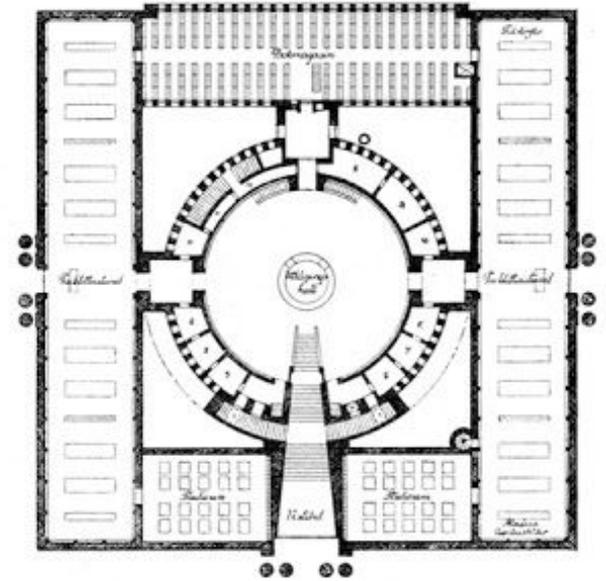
Grundriss der Stadtbibliothek in Stockholm, 1928
